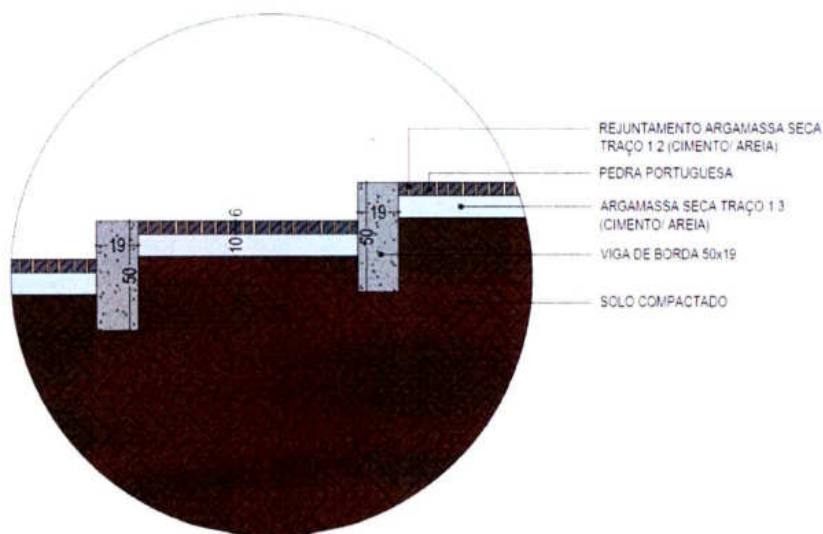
Corte Pavimentação Escada Principal - Viga de Borda e Pedra Portuguesa
